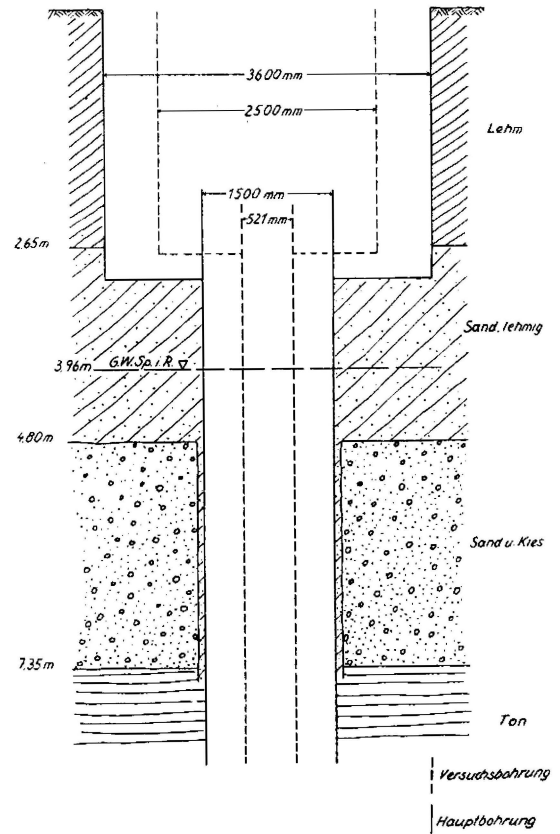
Unbeabsichtigte Abdichtung einer wasserführenden Kiesschicht
